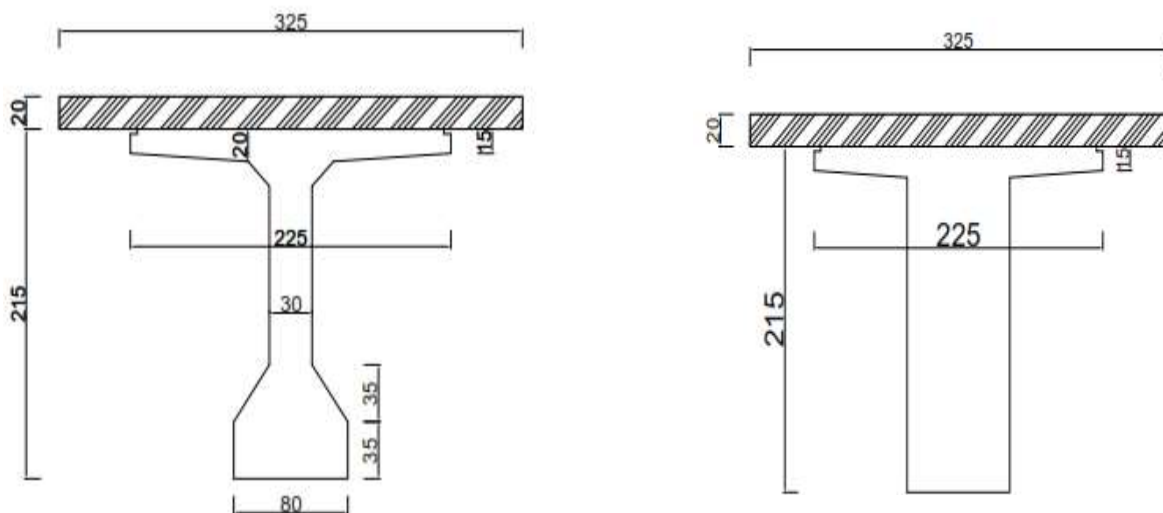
section de la poutre et du hourdis à mi- travée et sur appuis.
